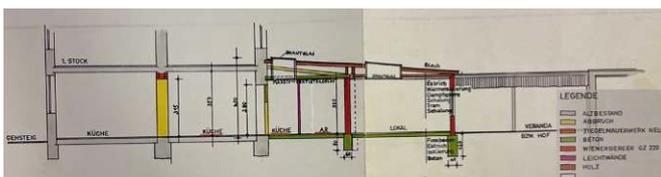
Schnitt Zubau Gasthaus, 1980
